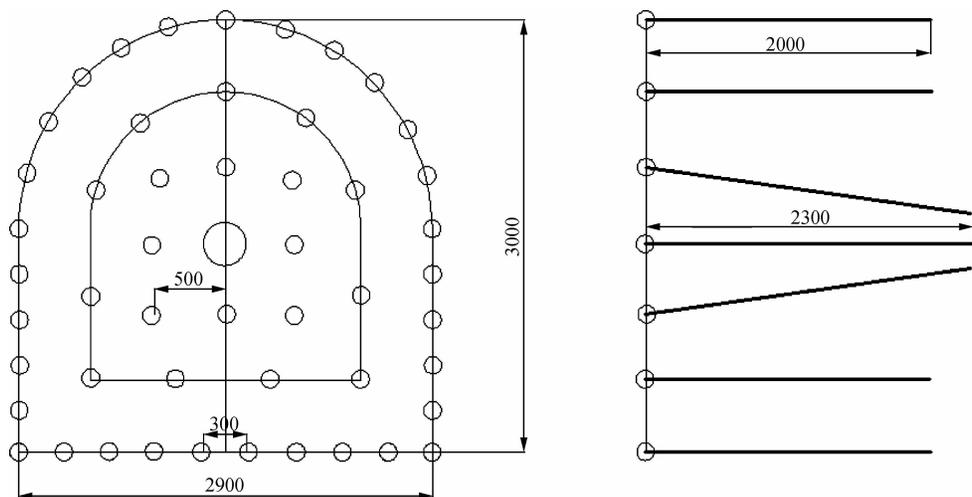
开挖爆破孔布置图及钻孔剖面(单位:mm)
